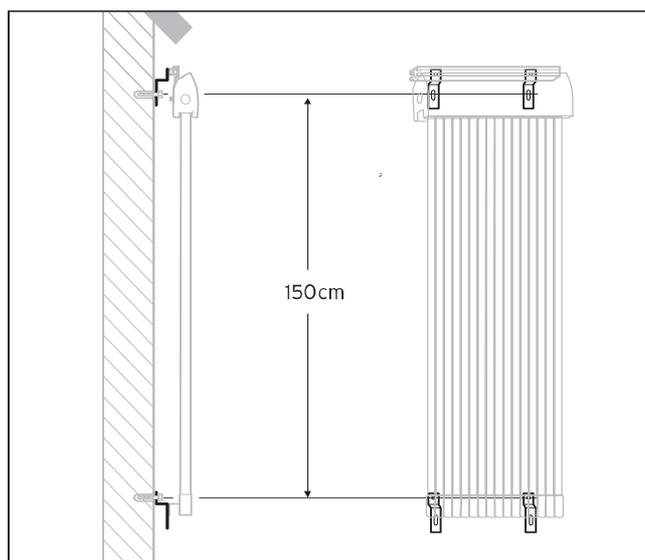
Расстояние между крюками при монтаже на фасаде
